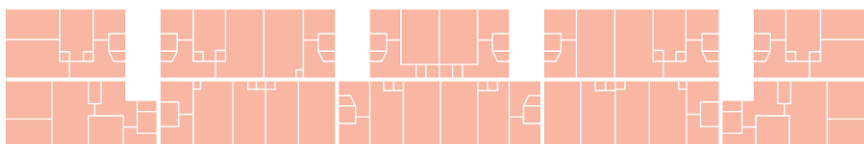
Расчетная площадь: Общая площадь минус стены и лестничные клетки
